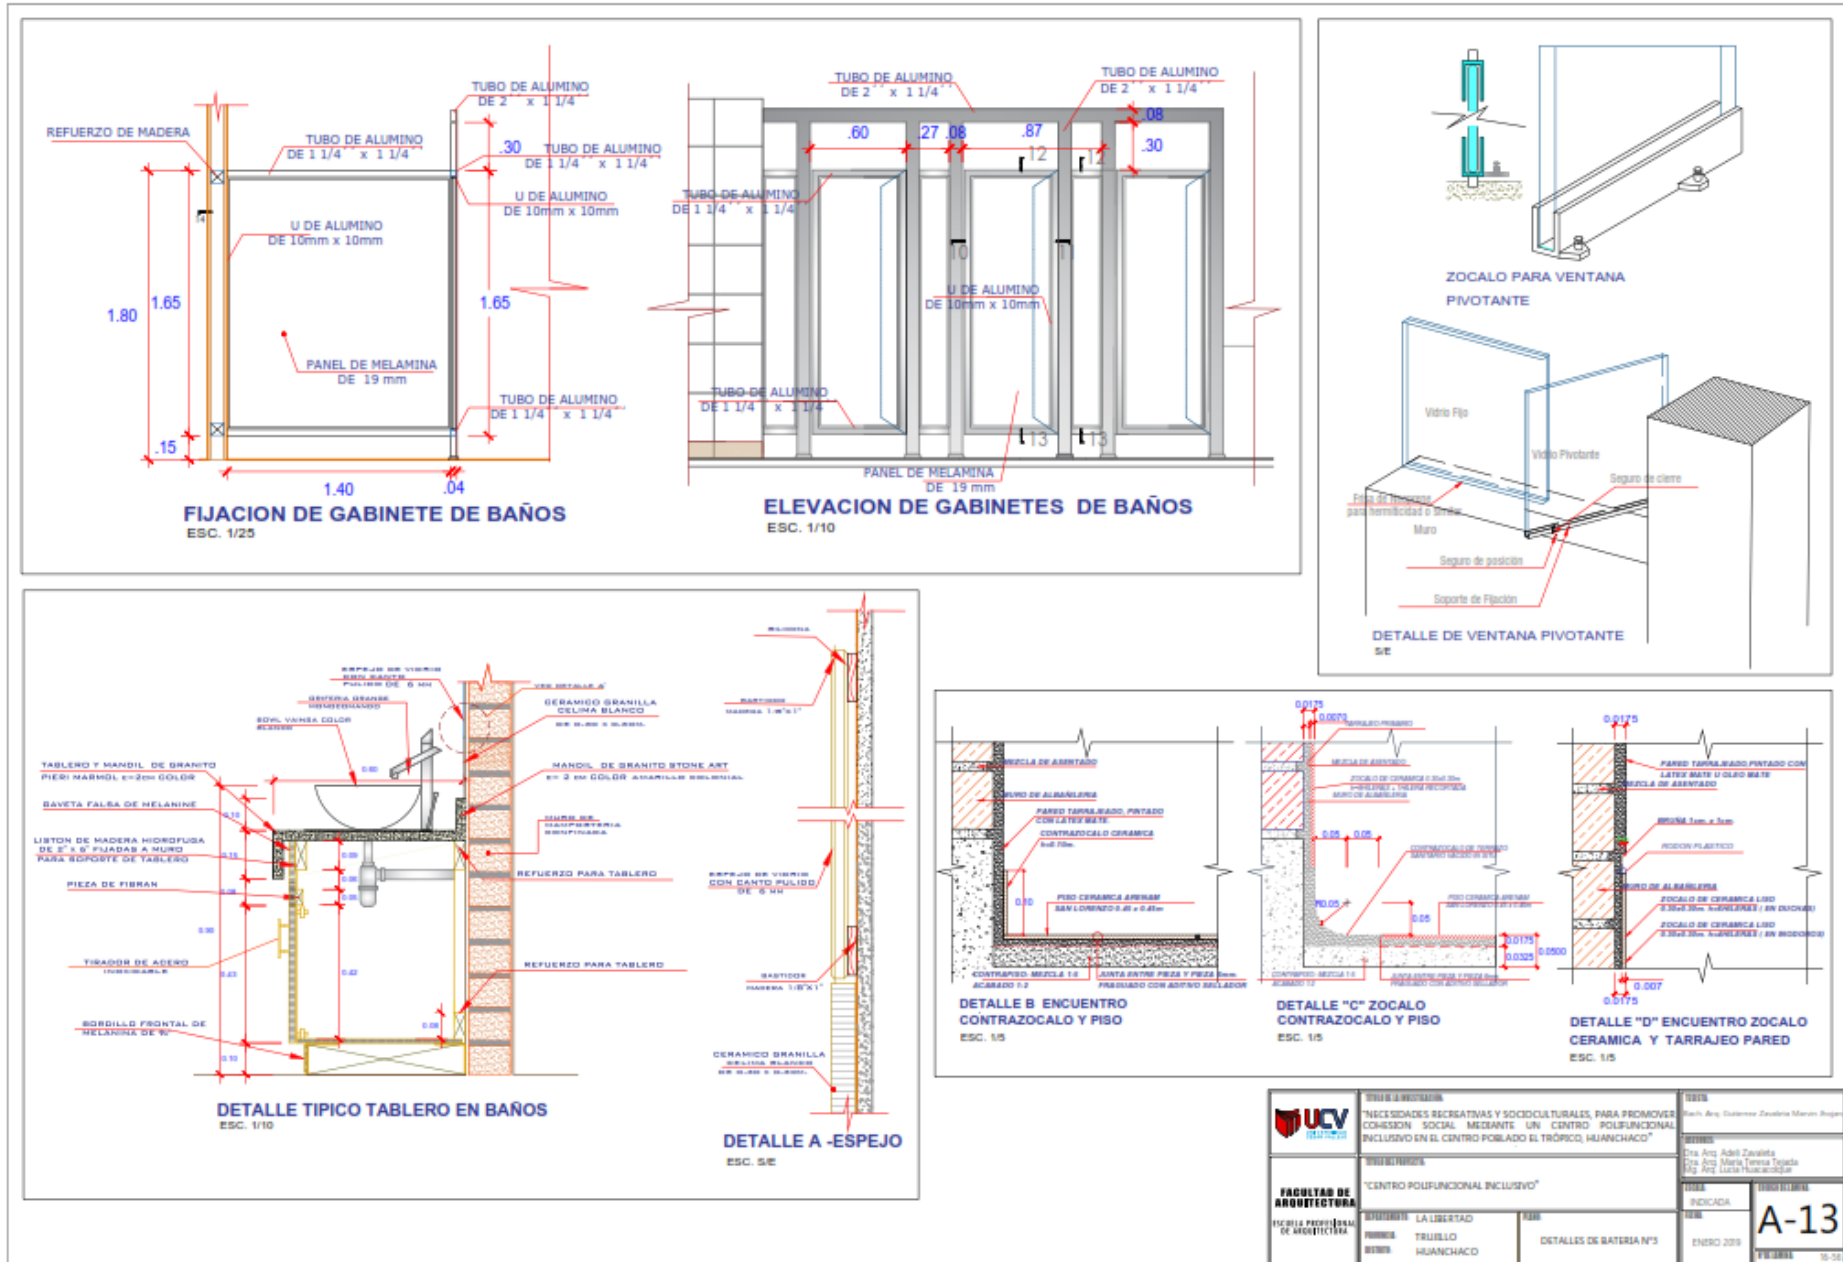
Desarrollo batería N° 3, detalles: A-13. Fuente: Propia (2018)
